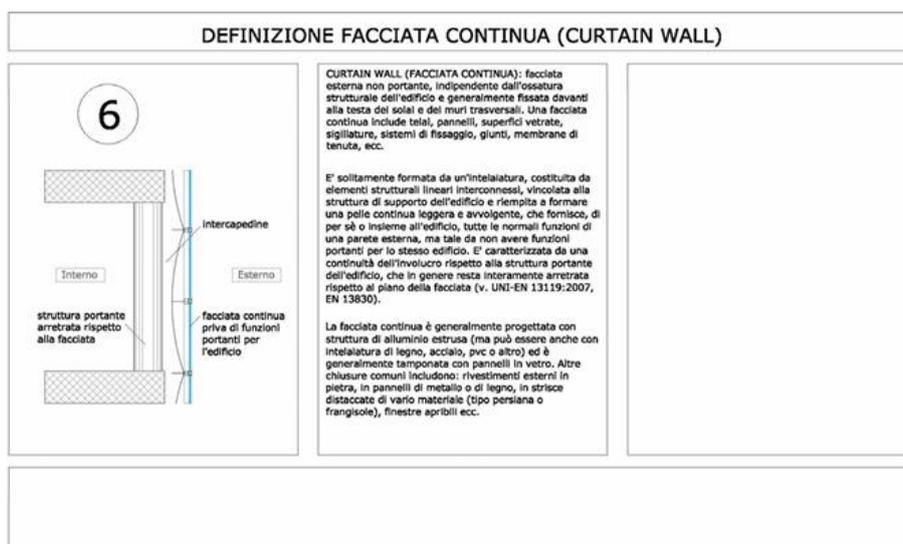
Definizione facciata continua (curtain wall) - (F.Cosi)
